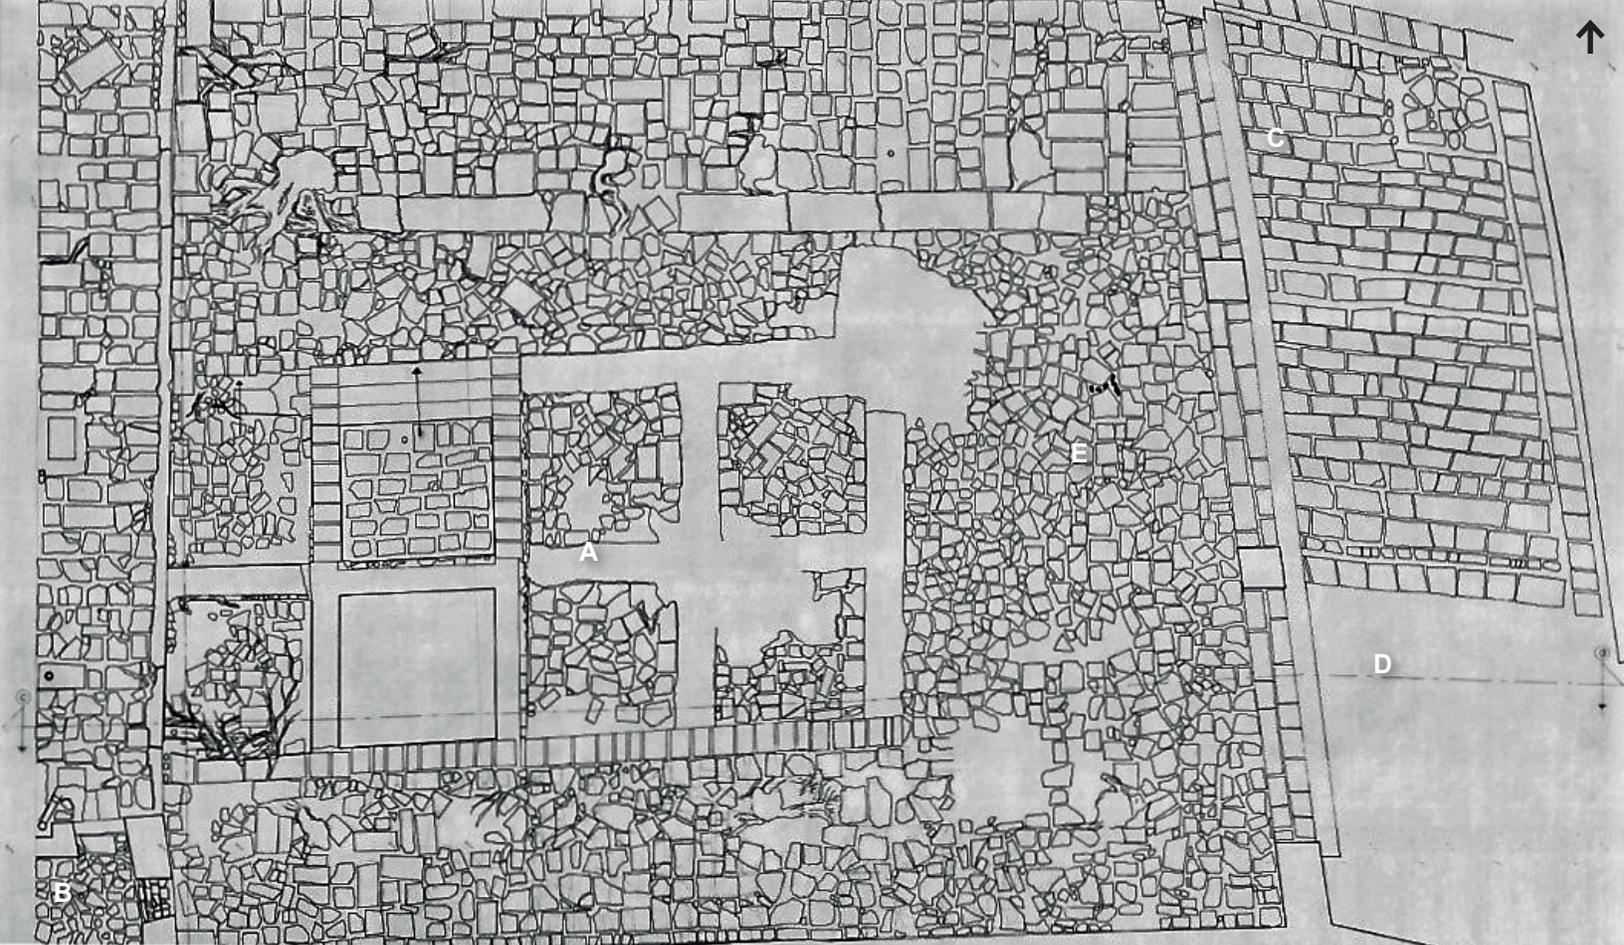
Plano arquitectónico de la Planta baja de la Casa Talavera donde se aprecian los espacios utilizados para los trabajos de la curtiduría. Fuente: Retomado del Archivo de la UACM [2010].
